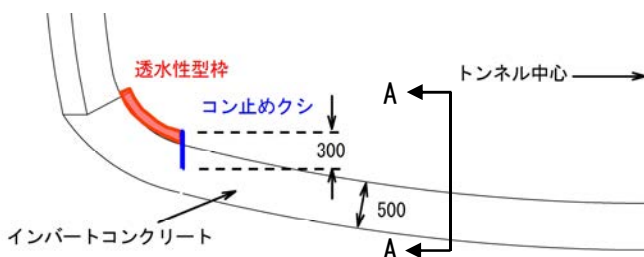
型枠断面図(A-Aは写真-2の撮影方向)
